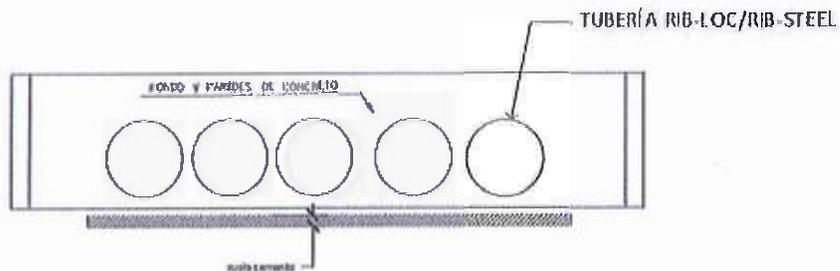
Sección transversal sistema de detención, utilizando tubería para almacenamiento.
